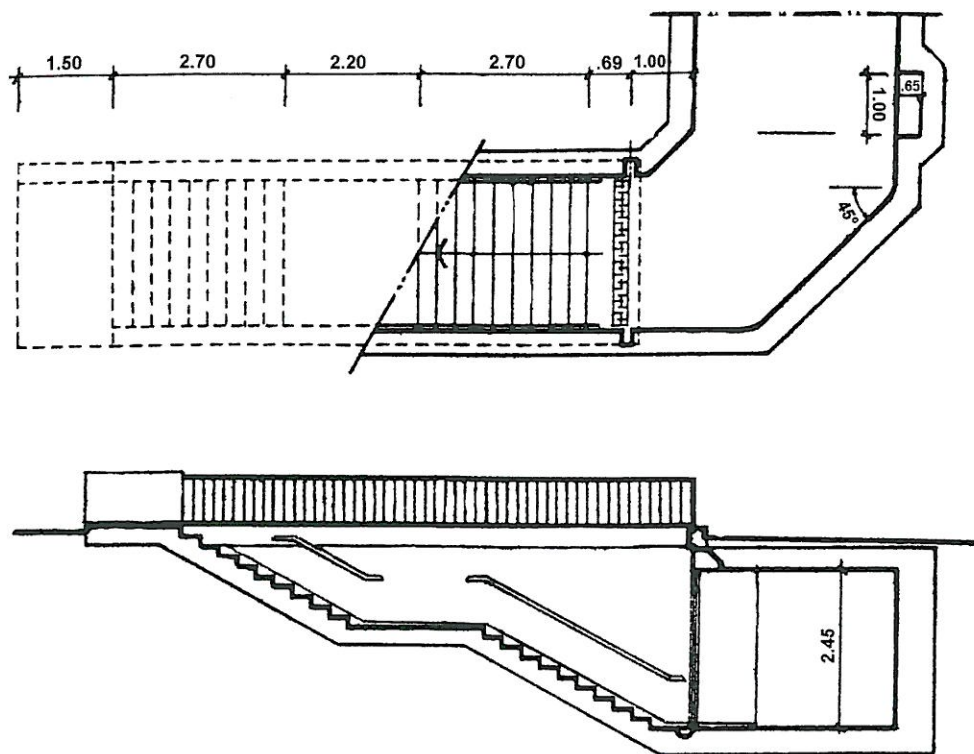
Escada para acesso a construção subterrânea (metropolitano)
